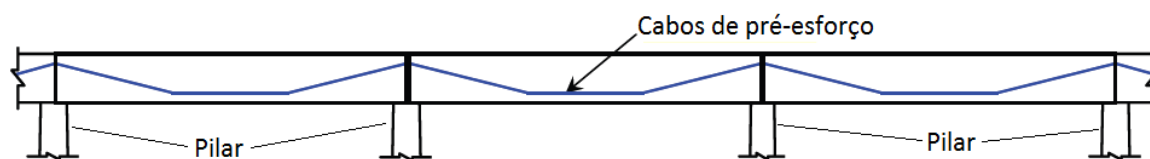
Traçado dos cabos de pré-esforço exterior não aderente na construção tramo a tramo (Adaptado de Veletz, M. J., 2007)
